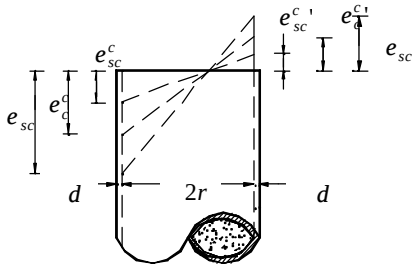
钢管混凝土大偏心受压构件徐变应变示意图
